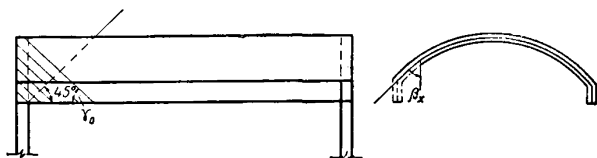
К определению поперечной и наклонной арматуры в цилиндрических оболочках
